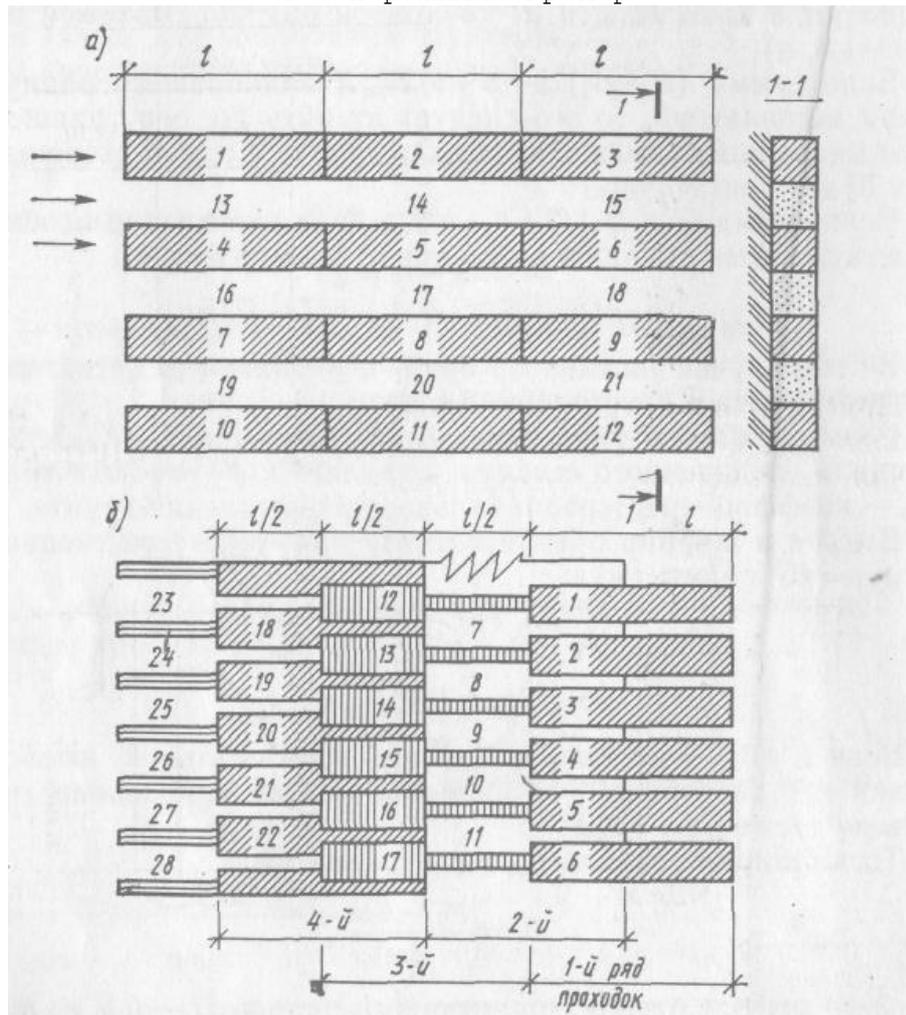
Схема разработки грунта скреперами при планировке площадок:
